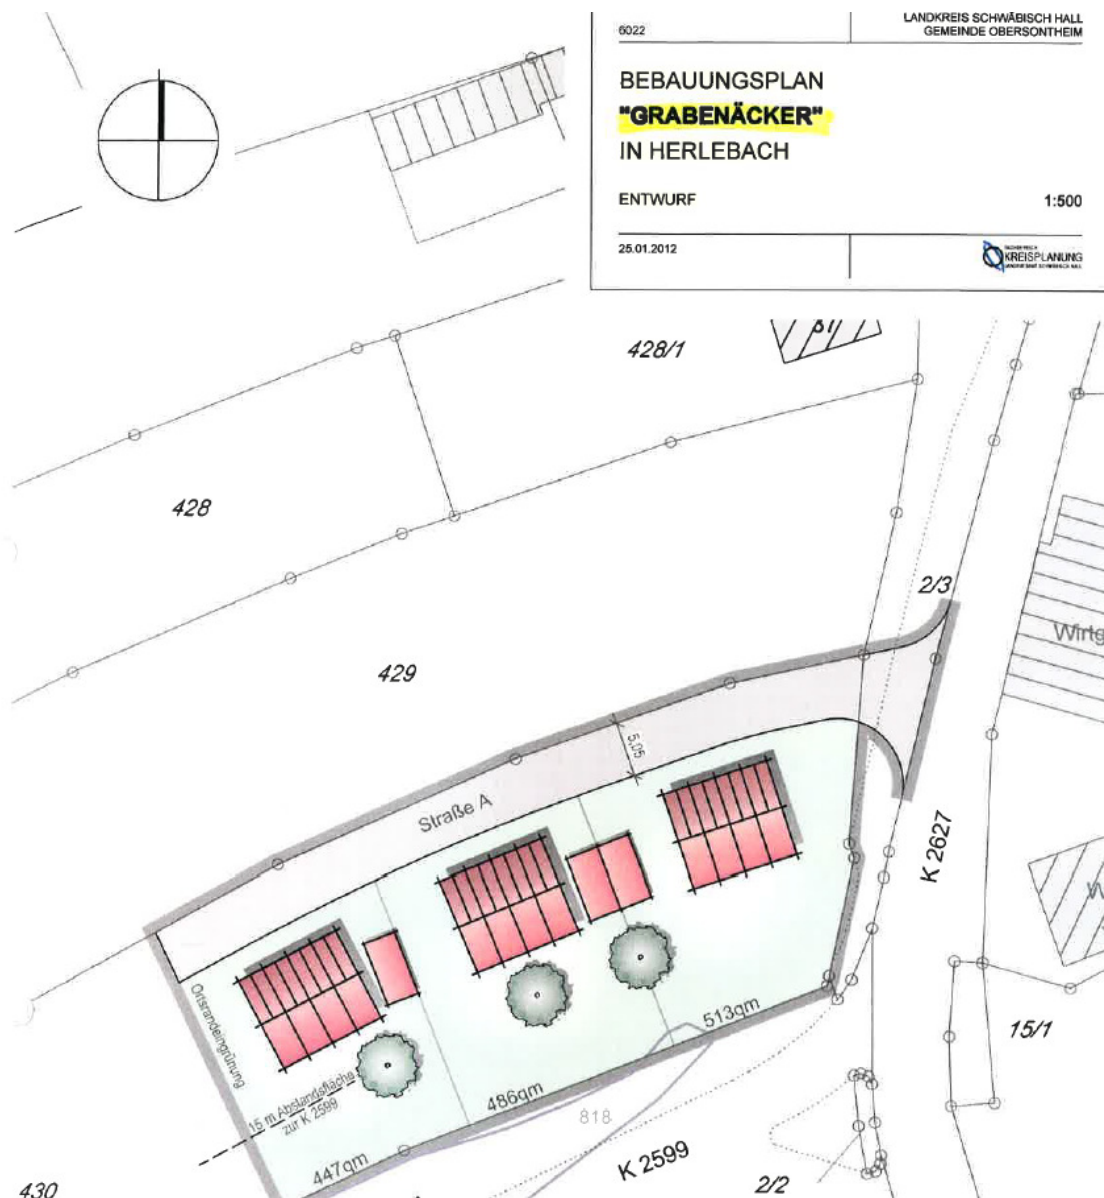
Lageplanausschnitt Bebauungsplan-Entwurf „Grabenäcker“ aus dem Jahr 2012, o.M.
